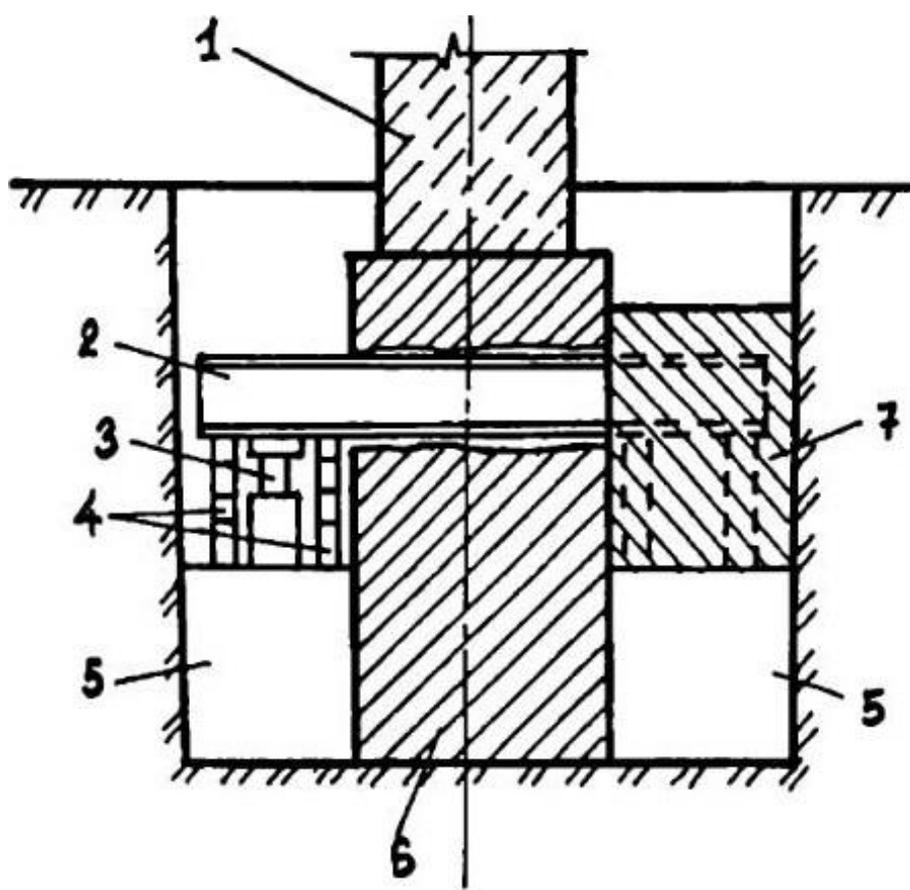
Схема уширения подошвы ленточного фундамента с обжатием грунта домкратом: 1 – стена; 2 – пакет из стальных балок; 3 – домкрат; 4 – клинья; 5 – железобетонный банкет; 6 – усиливаемый фундамент, 7 – бетон, укладываемый после извлечения домкратов.
